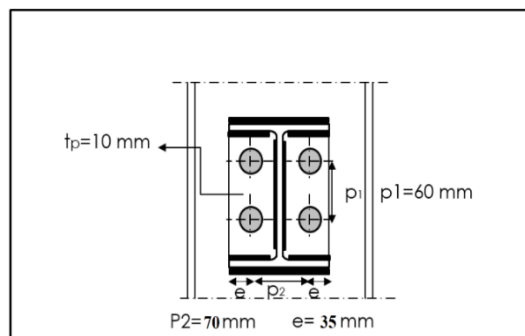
Détail de l'assemblage poteau – sablière
